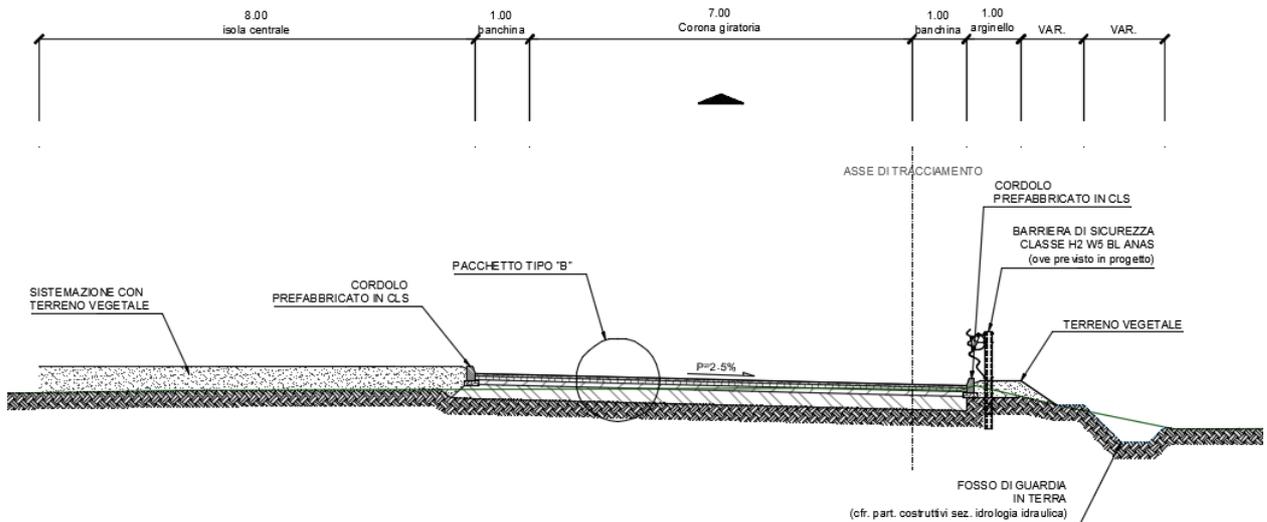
Sezione tipo rotatoria Strada Vicinale San Pancrazio
